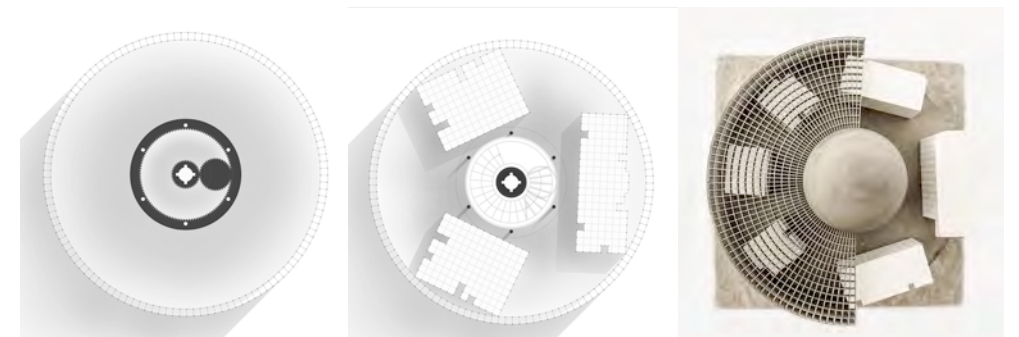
S. Freemanhouse Grundriss, Wandstruktur, Verhältnis, innen und außen
